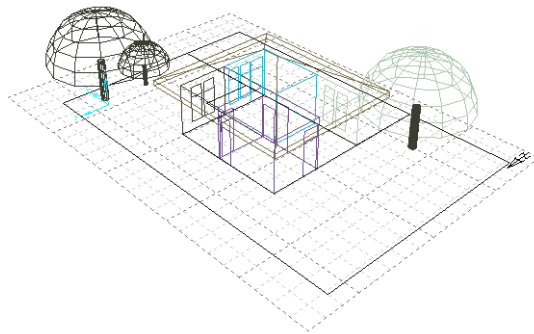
Denah Pengembangan 2 Konsep Desain *Renovable
